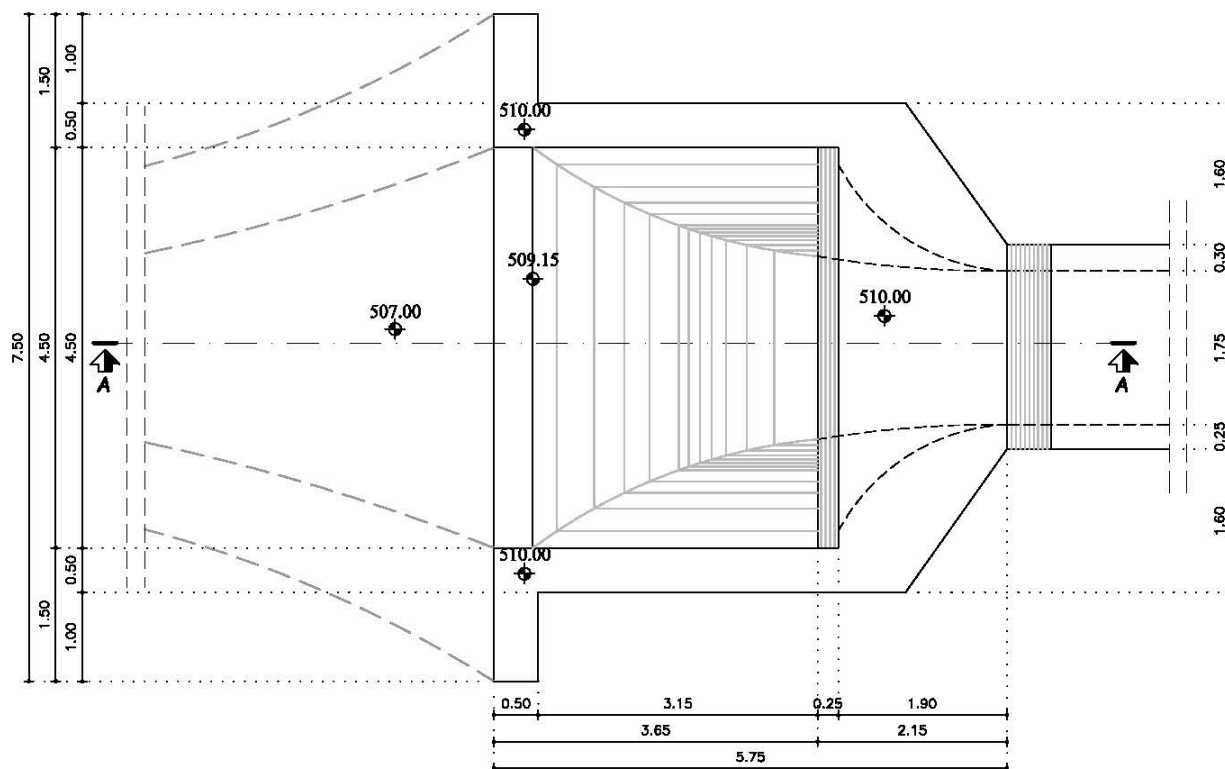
Pianta dell'imbocco dello scarico di fondo
